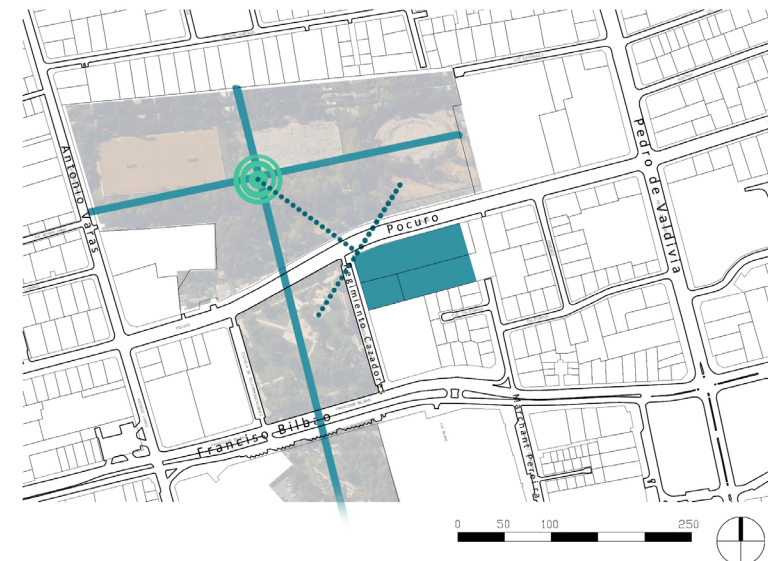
Plano Áreas Verdes. Enfrentamiento Ubicación del proyecto a Centro gravedad Parque " Los Estanques". Elaboración propia
